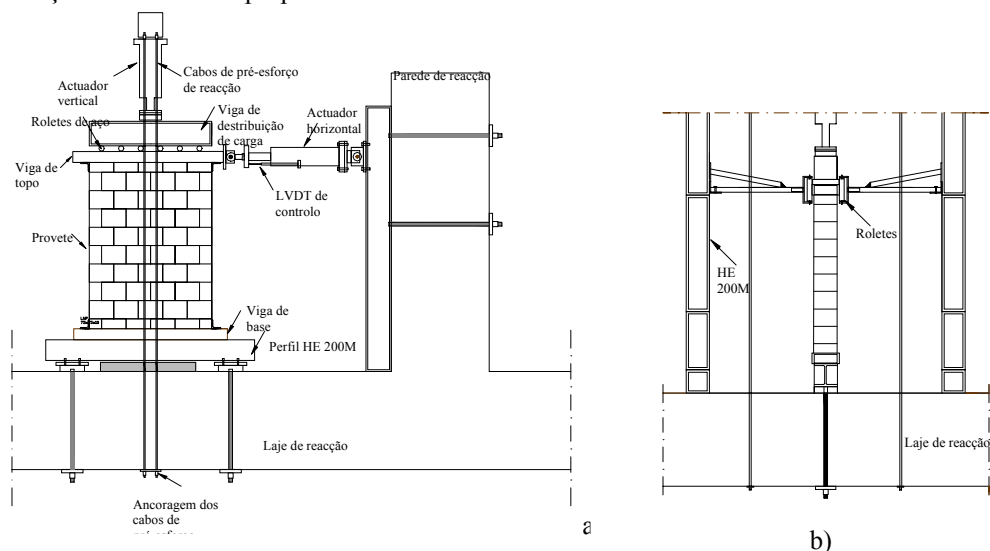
Esquema estrutural do ensaio; a) vista frontal; b) vista lateral
